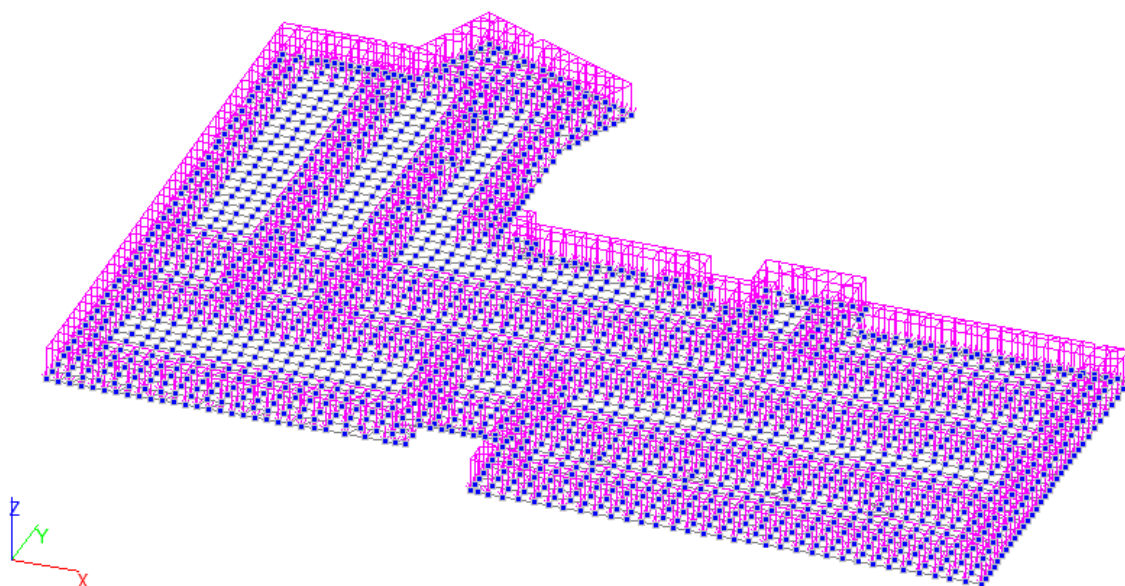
Схема действия нагрузок на фундаментную плиту
